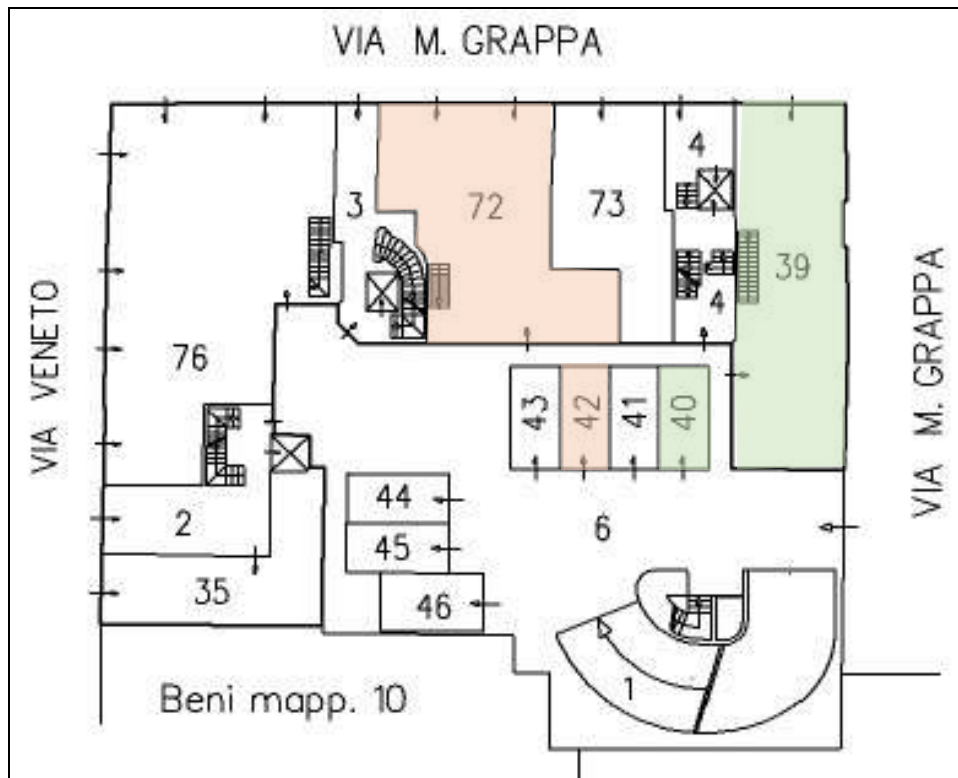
Estratto elaborato planimetrico: piano terra – indicazione lotti
